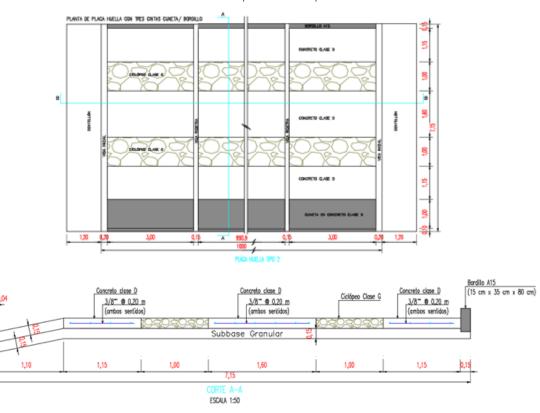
Detalles de placa huella Tipo 2 - Caso 1
